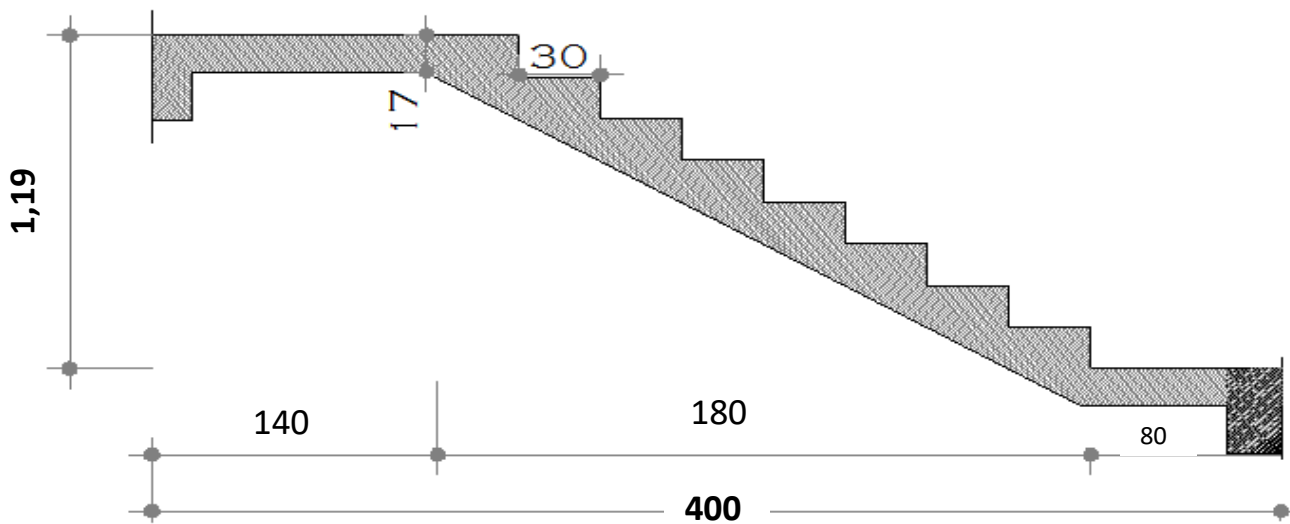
Coupe verticale d'une volée de l'escalier de l'étage courant.
